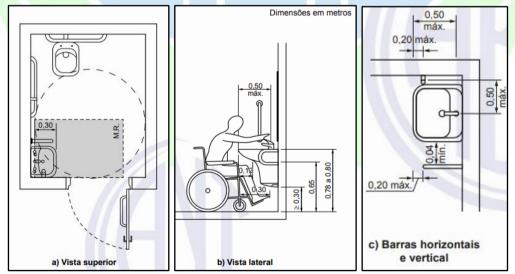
Dimensões para instalação das barras de apoio para lavatório conforme NBR 9050/2020
